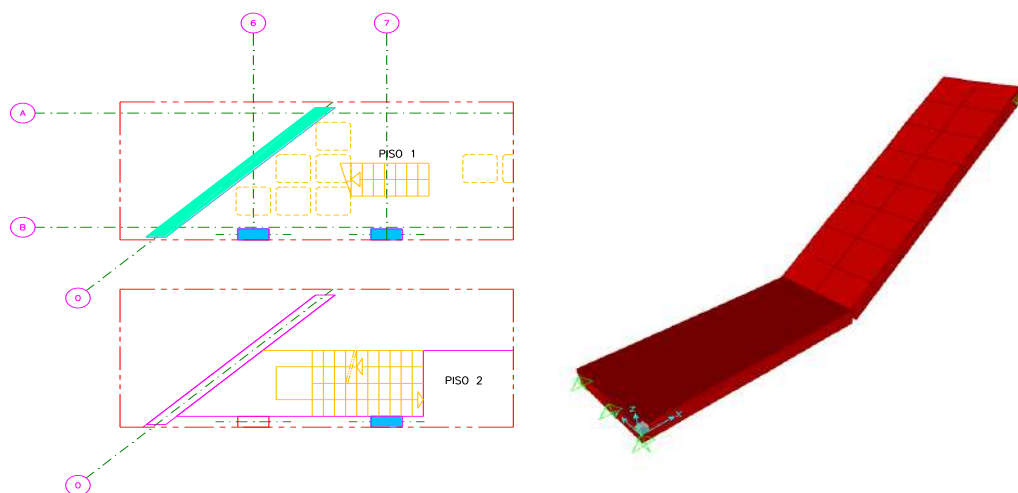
Planta e respectivo modelo de cálculo da escada tipo "E1"
